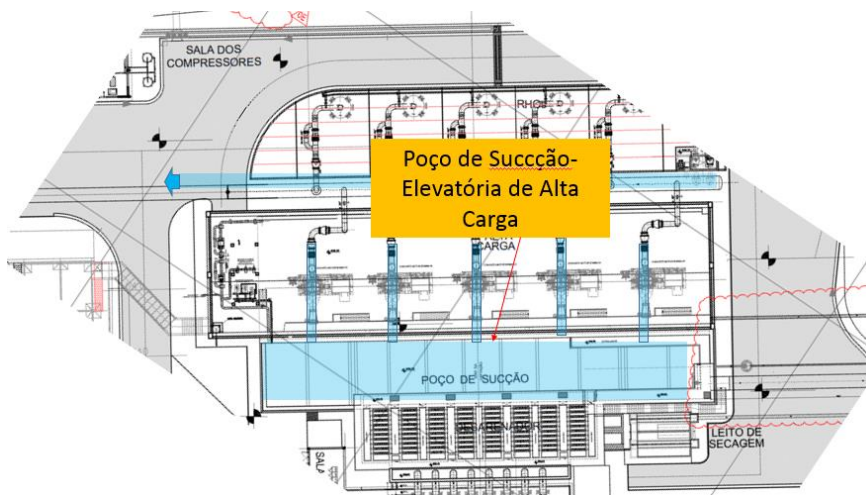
Poço de sucção da Estação Elevatória de Alta Carga, vista em Planta
